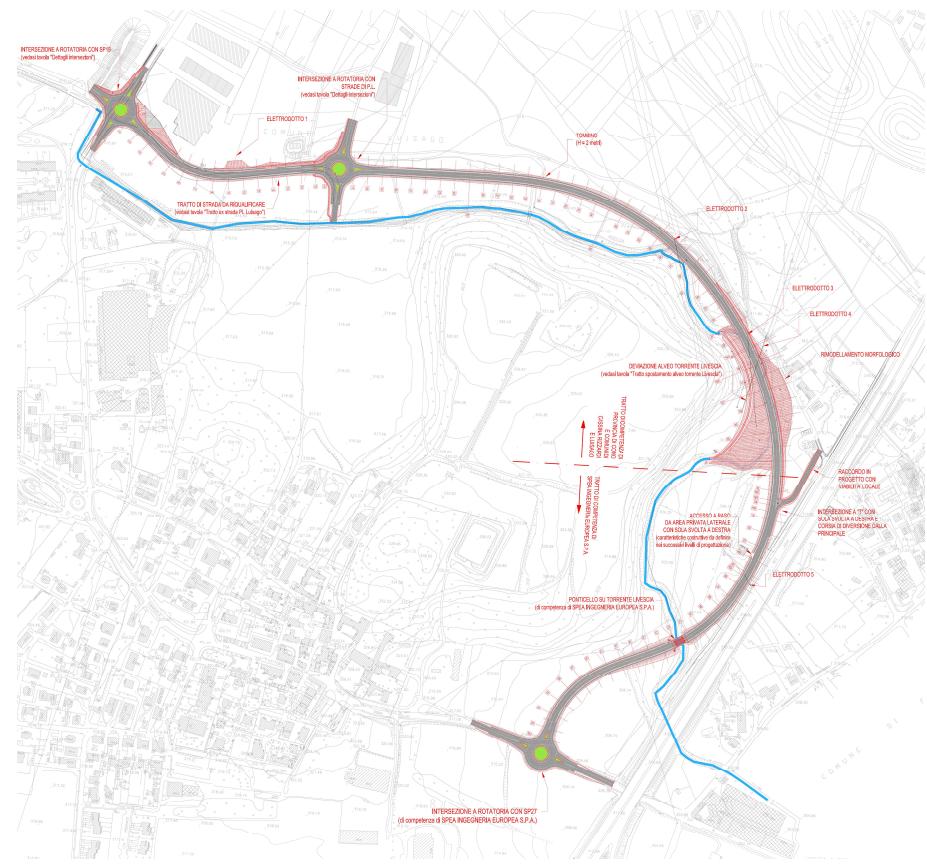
Progetto preliminare Collegamento SP27-SP19
